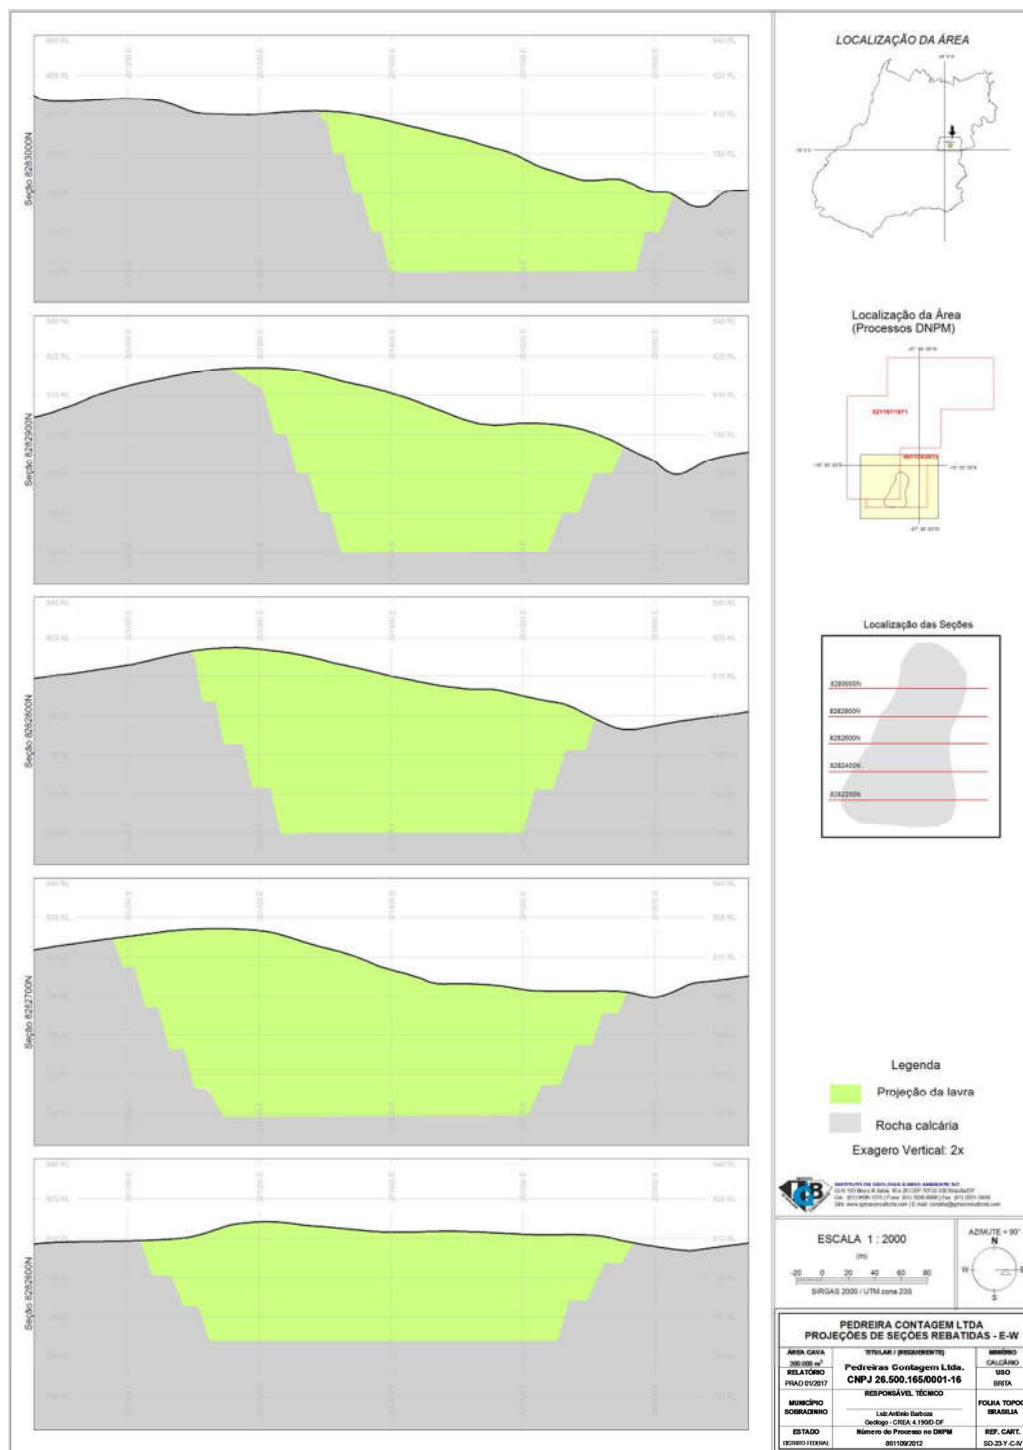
Figura: Seções verticais rebatidas Oeste-Leste.
